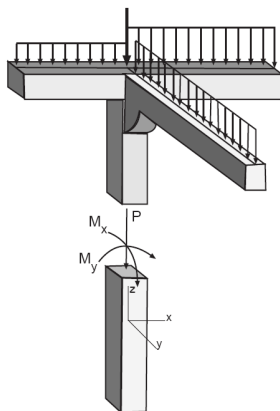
Cargas aplicadas nos pilares por vigas, e lajes.
